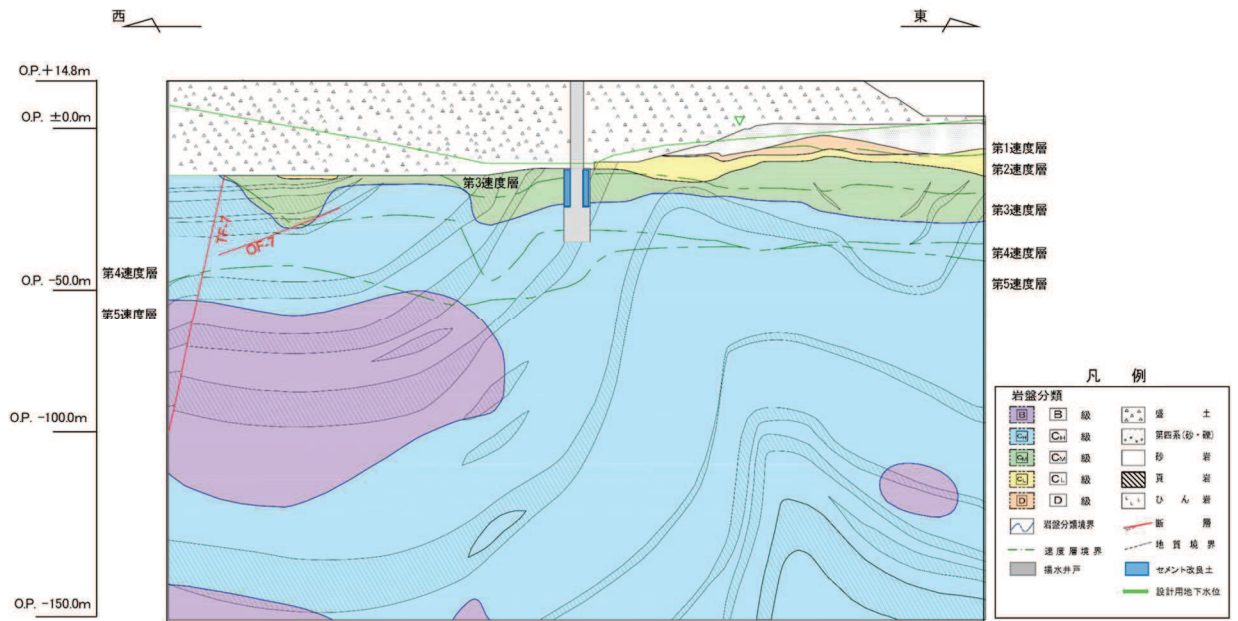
(4) No. 4 揚水井戸 評価対象断面図 (D' -D 断面)
